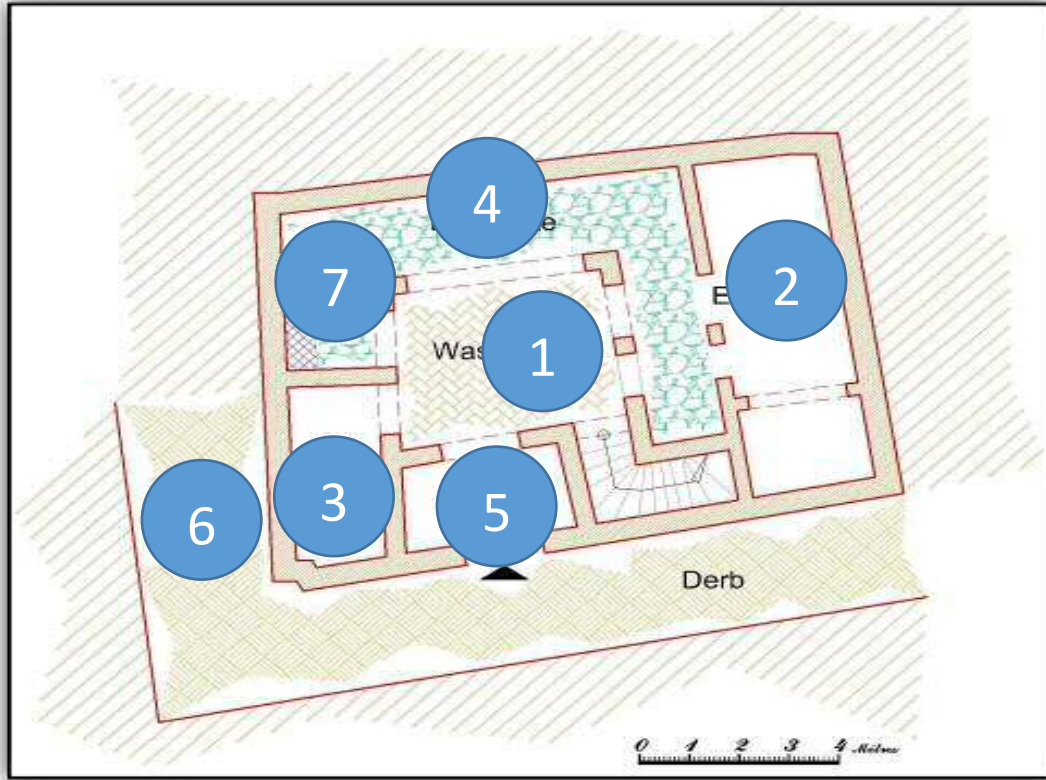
Plan du rez de chaussée de Dar Tchouar.
